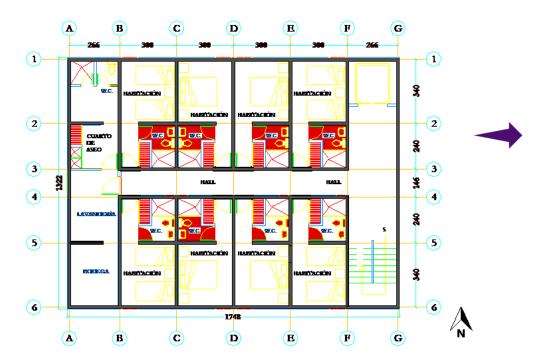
Planta Arquitectónica Hotel Modular: Caso Estudio #1
